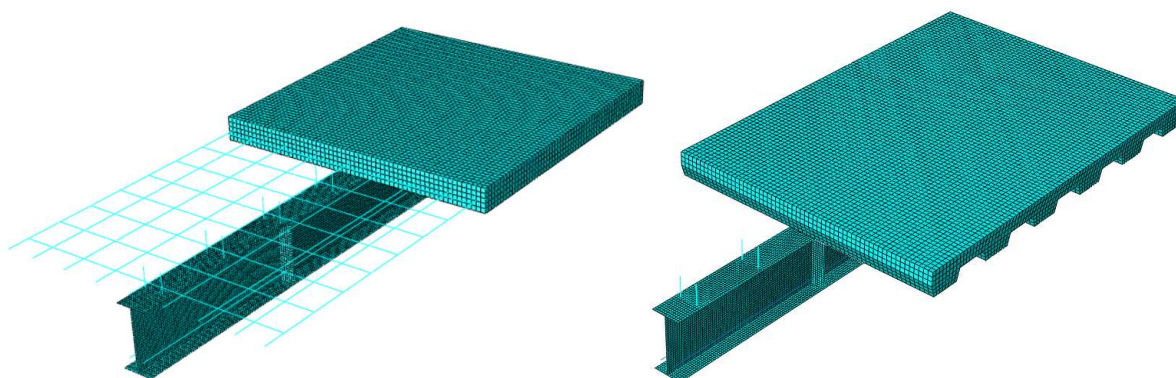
Elementos do modelo numérico para vigas mistas de aço e concreto protendidas com laje mista
